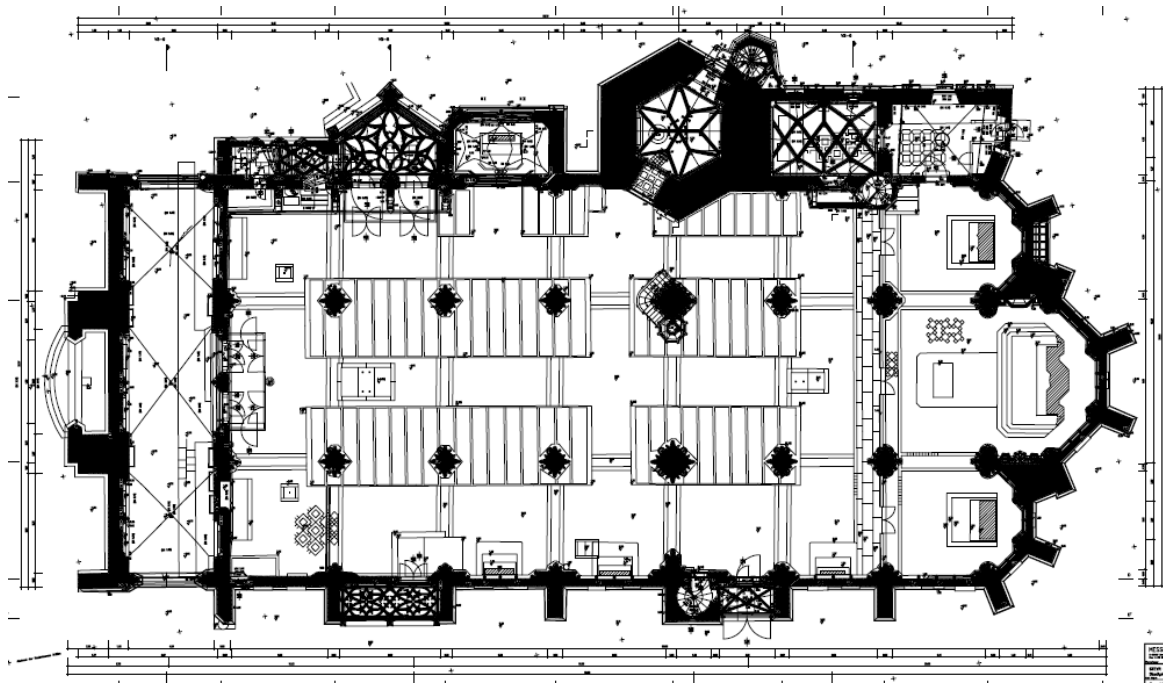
Steyr, Stadtpfarrkirche, Grundriss
